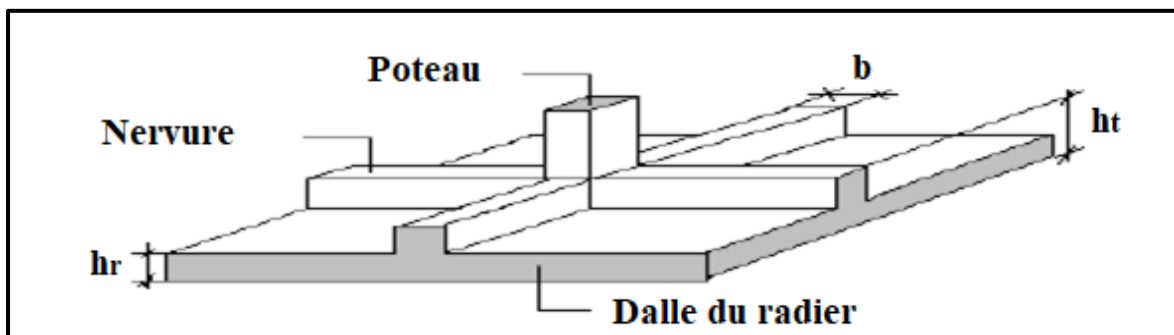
Disposition des nervures par rapport au radier et aux poteaux.
